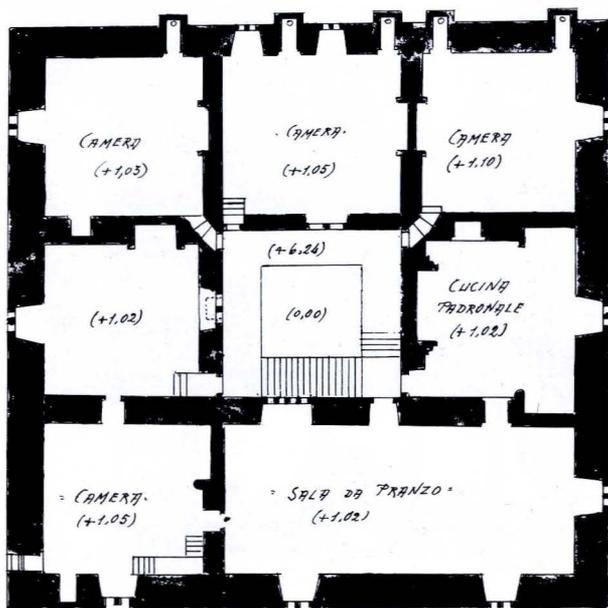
Castello di Verrès. Pianta del pianterreno.
